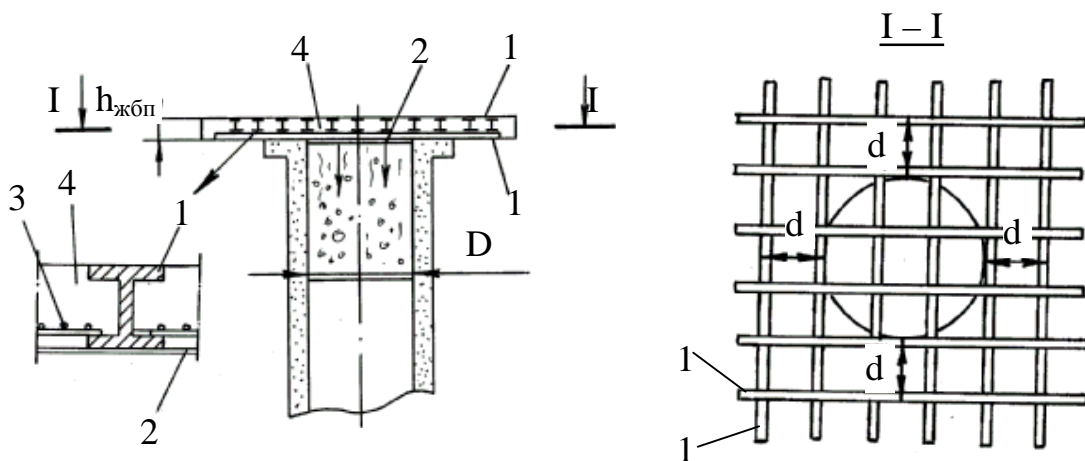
Конструкция плитки перекрытия устья вертикального ствола ($h_{жбп} \geq 0,1D$): 1 – двутавр; 2 – опалубка; 3 – арматура; 4 – бетон
